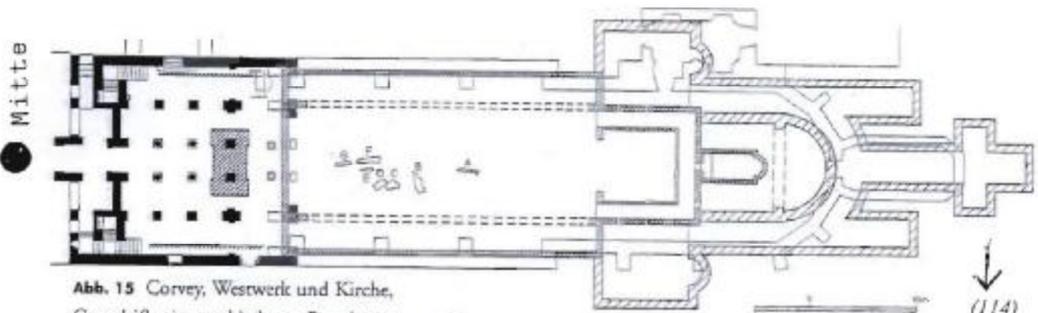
Corvey, Westwerk und Kirche, Grundriß mit verschiedenen Bauphasen, Zeichnung Frohnert
